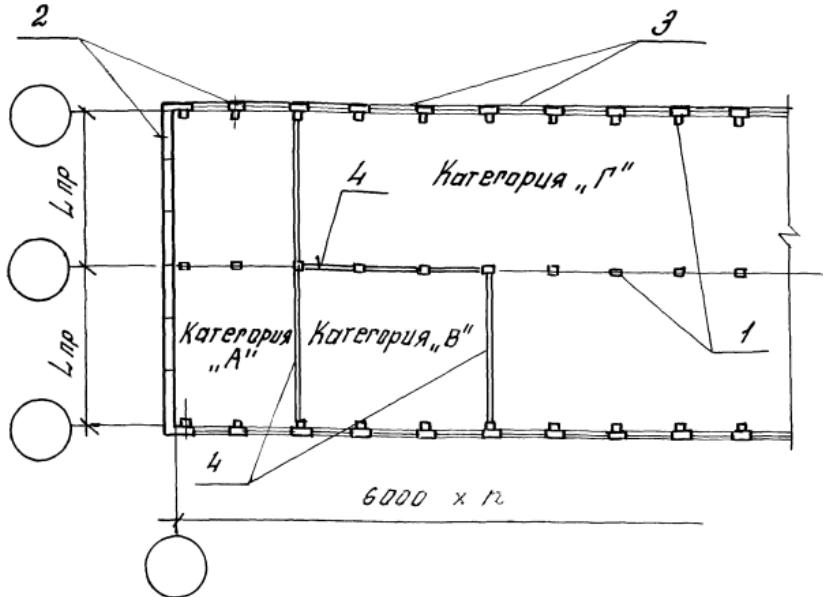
Пример расположения противопожарных перегородок в плане здания со стенами из негорючих материалов
